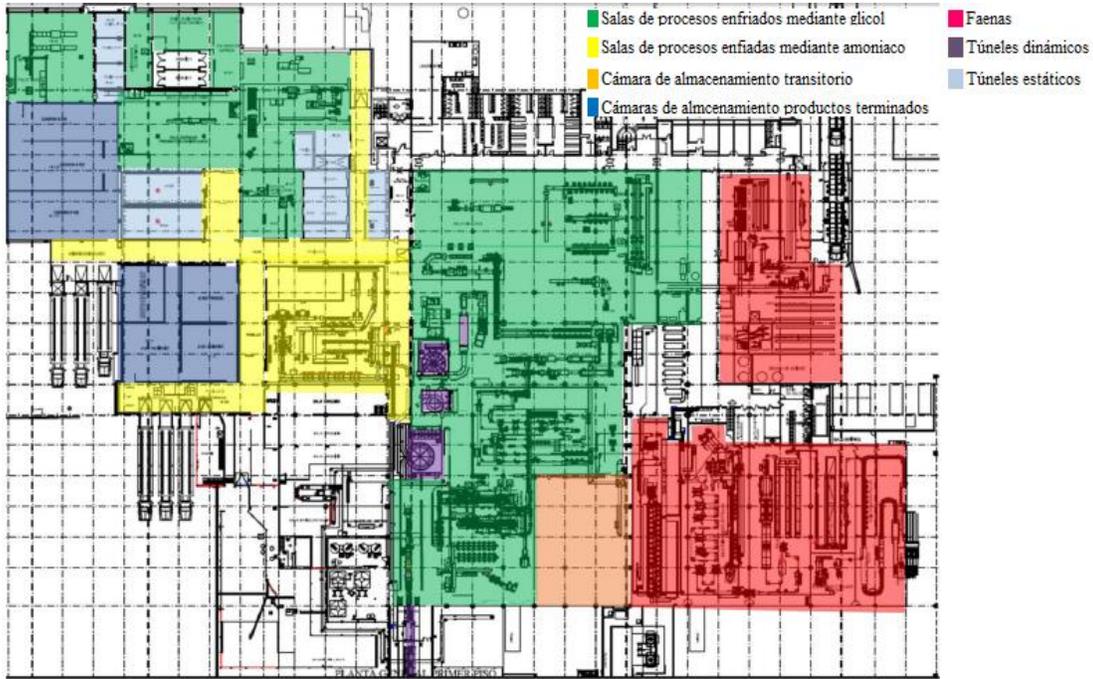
Plano de planta con colores destacando cada zona del proceso productivo
